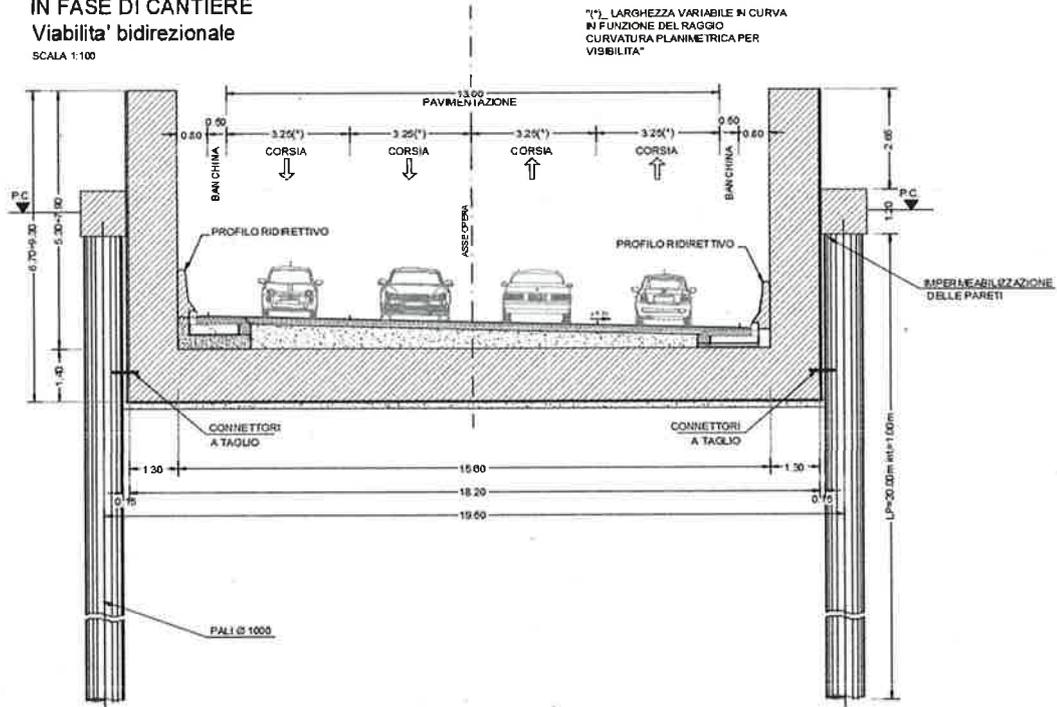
Sezione trasversale in trincea sottopasso dell'Oreficeria – Fase di cantiere
